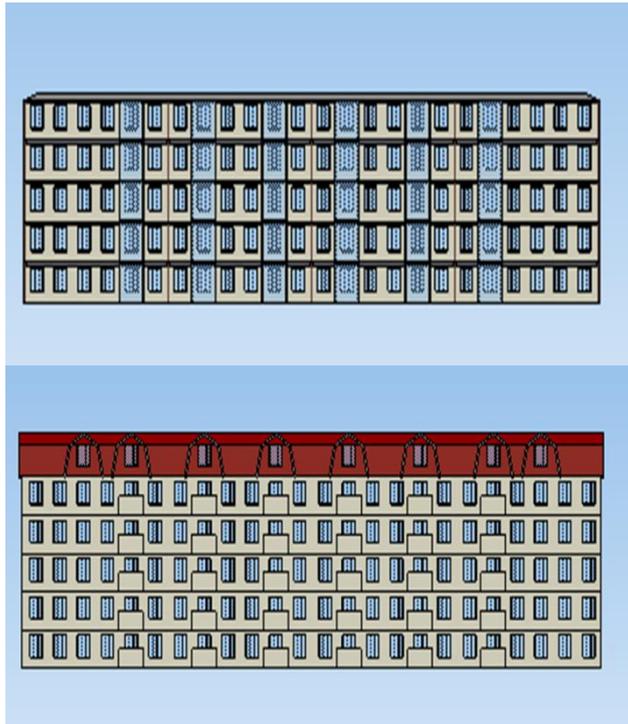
Вариант реконструкции с использованием надстройки мансардного этажа
